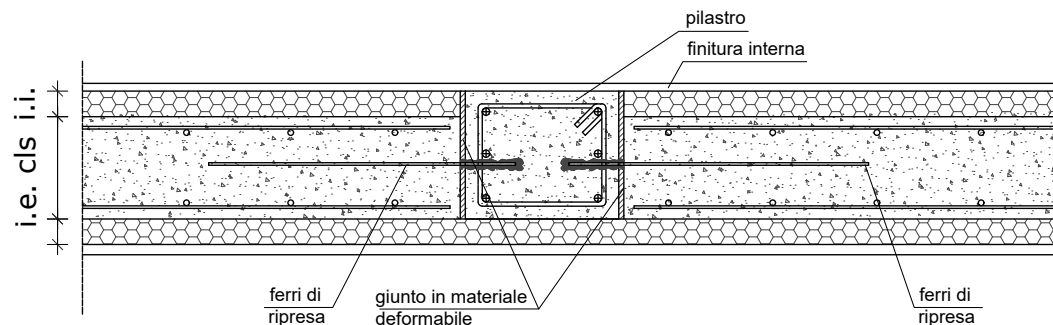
Pianta di una parete di tamponamento realizzata in ICF che si collega ad un pilastro contenuto nello spessore della stessa.
